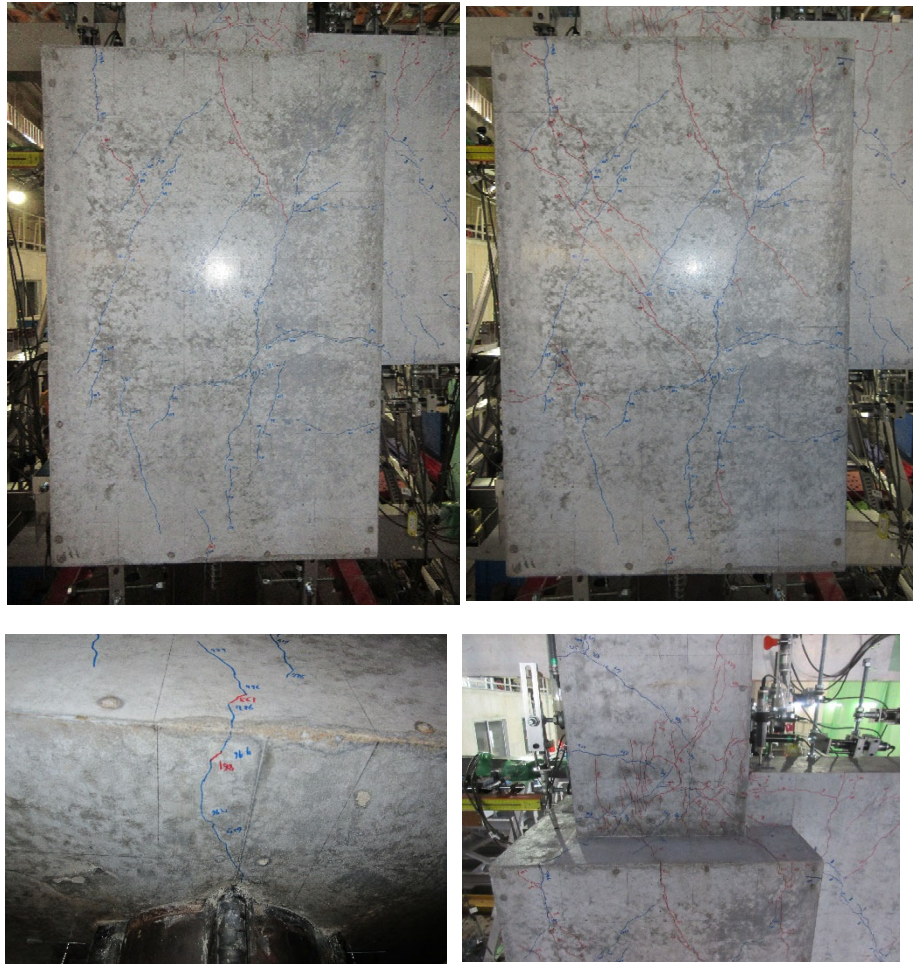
最大耐力時ひび割れ状況
